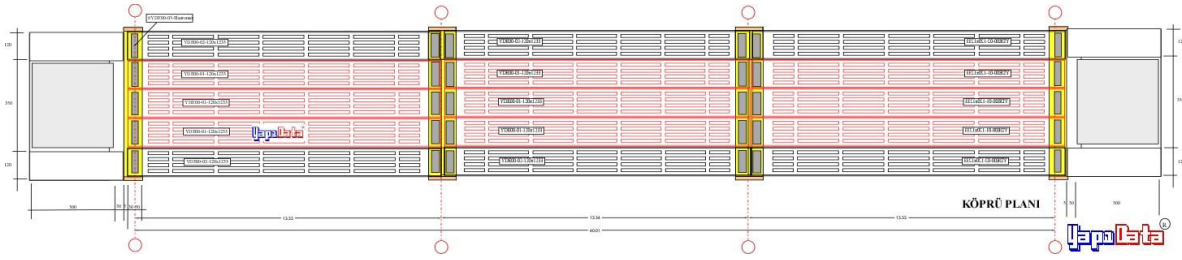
Bir betonarme döşeme köprü (<http://www.yildiz.edu.tr/~kircil/kopru>)
